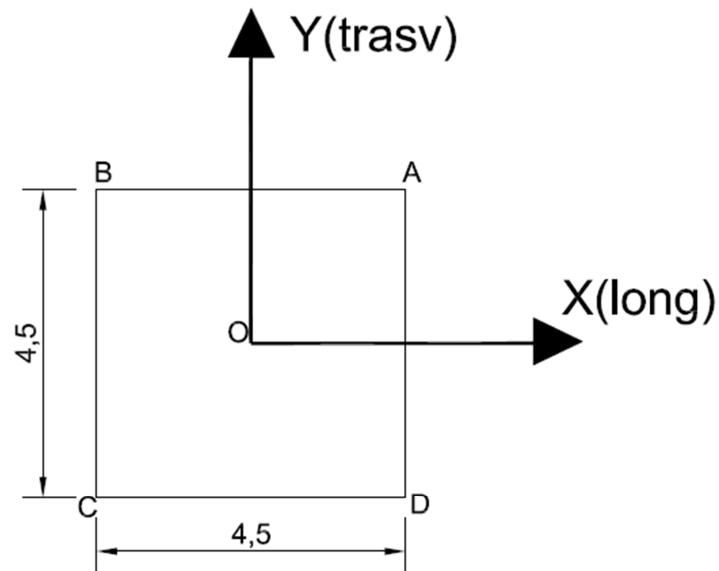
fondazione diretta pila (singola) 4,5x4,5 m
